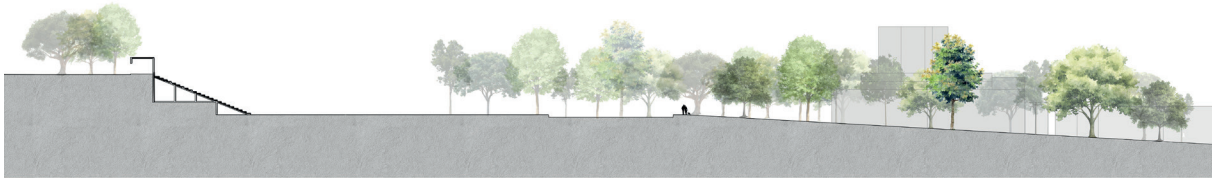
Corte longitudinal do terreno, e do estádio. Realizado em Cad pela autora.
